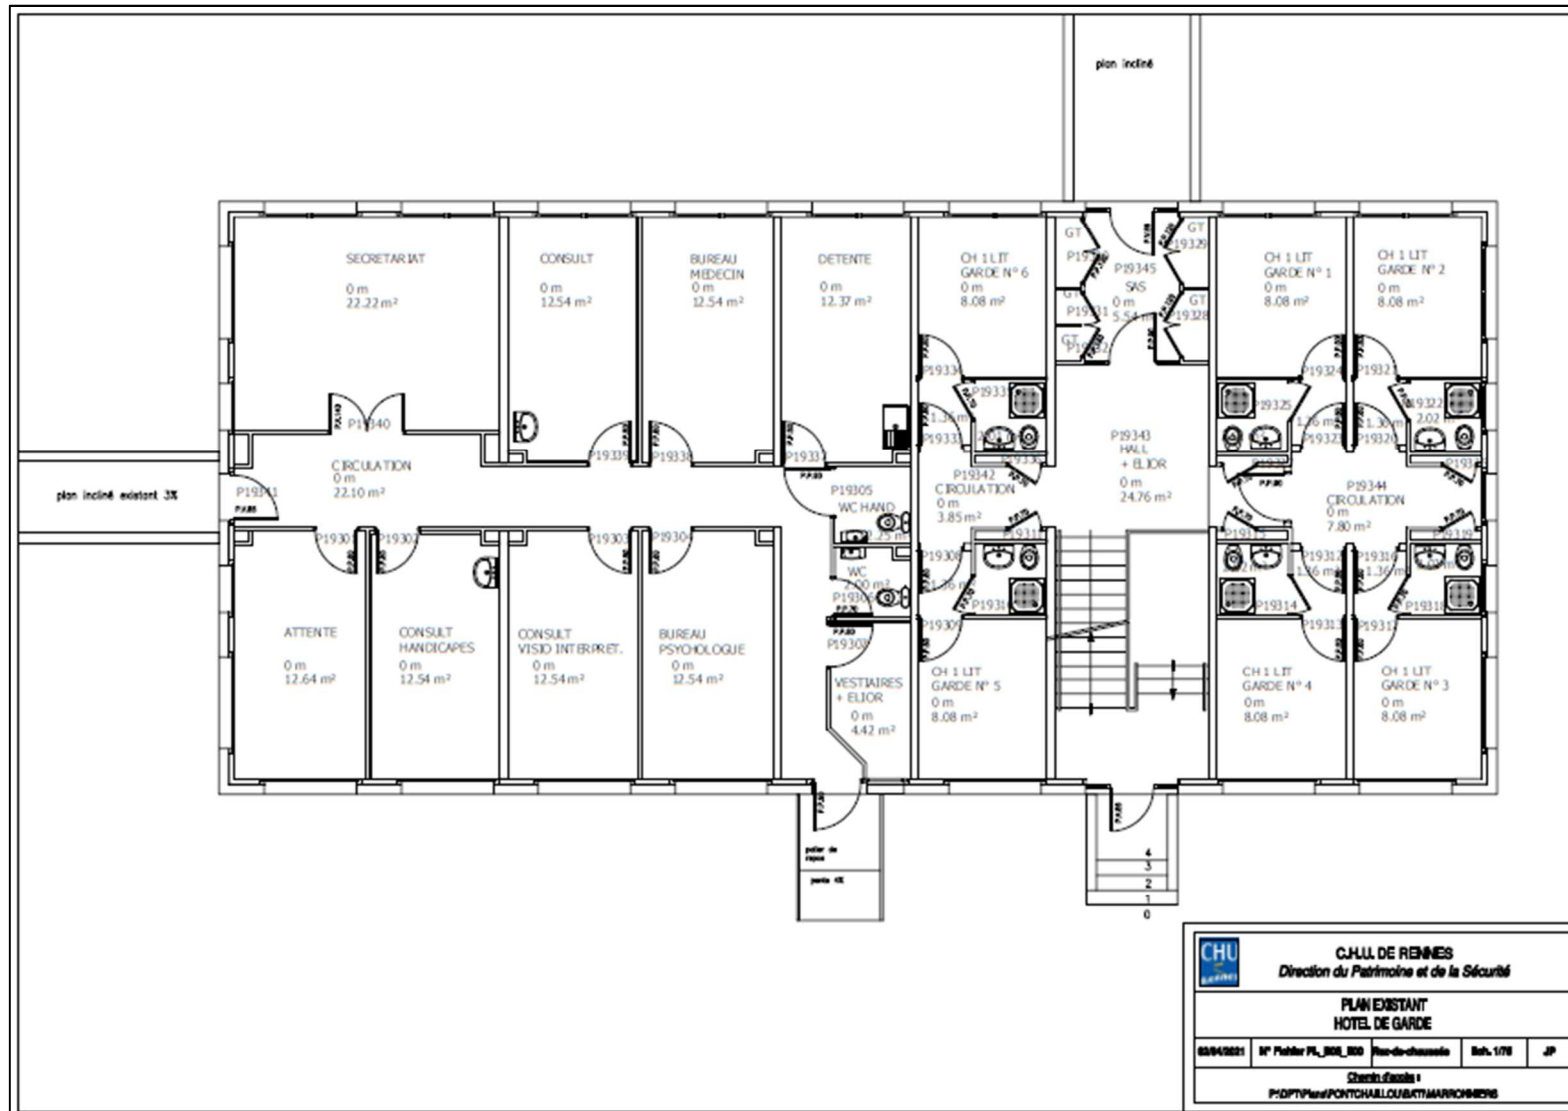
Plan de masse – Hôtel de garde – (Rez-de-chaussée) (Source : CHU Pontchaillou)
